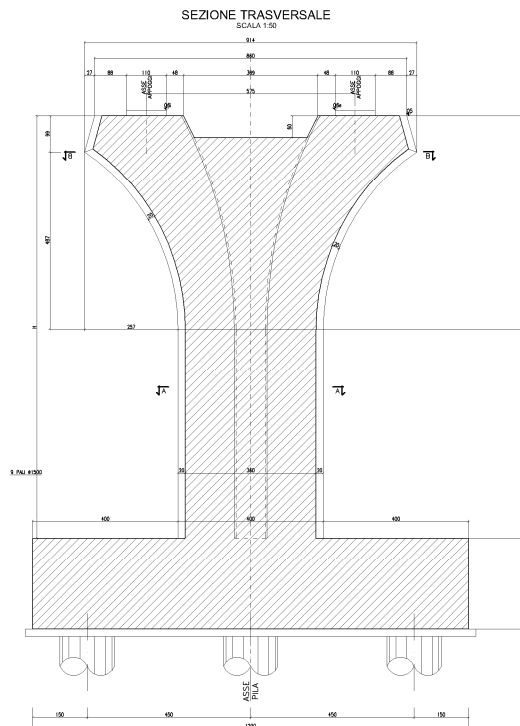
Sezione trasversale con fondazione tipo A.
